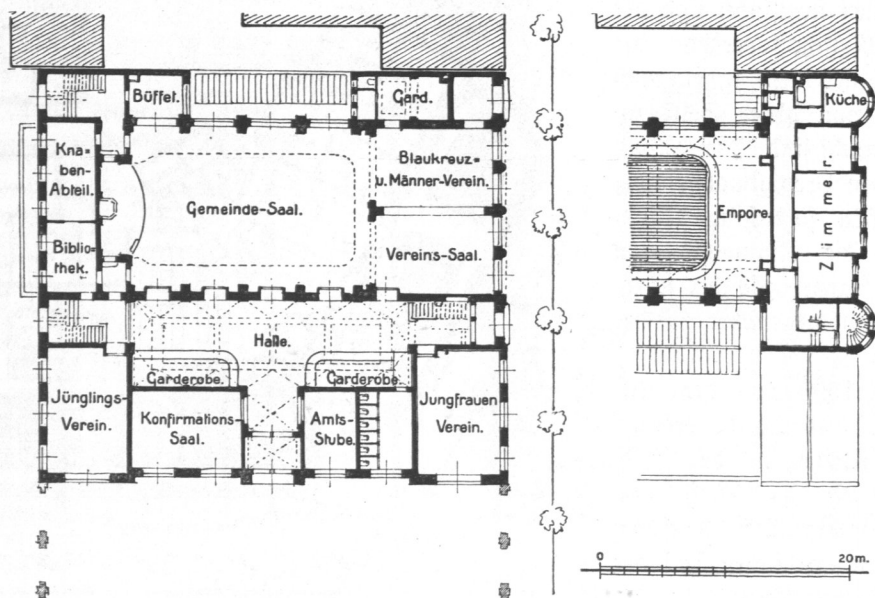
und 161a. Gemeindehaus der Kreuzkirche in Barmbeck, Grundrisse.
